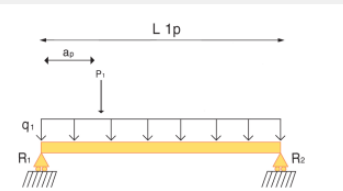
tipo apoyo; Fuente: (Silva & Valencia, 2023)
